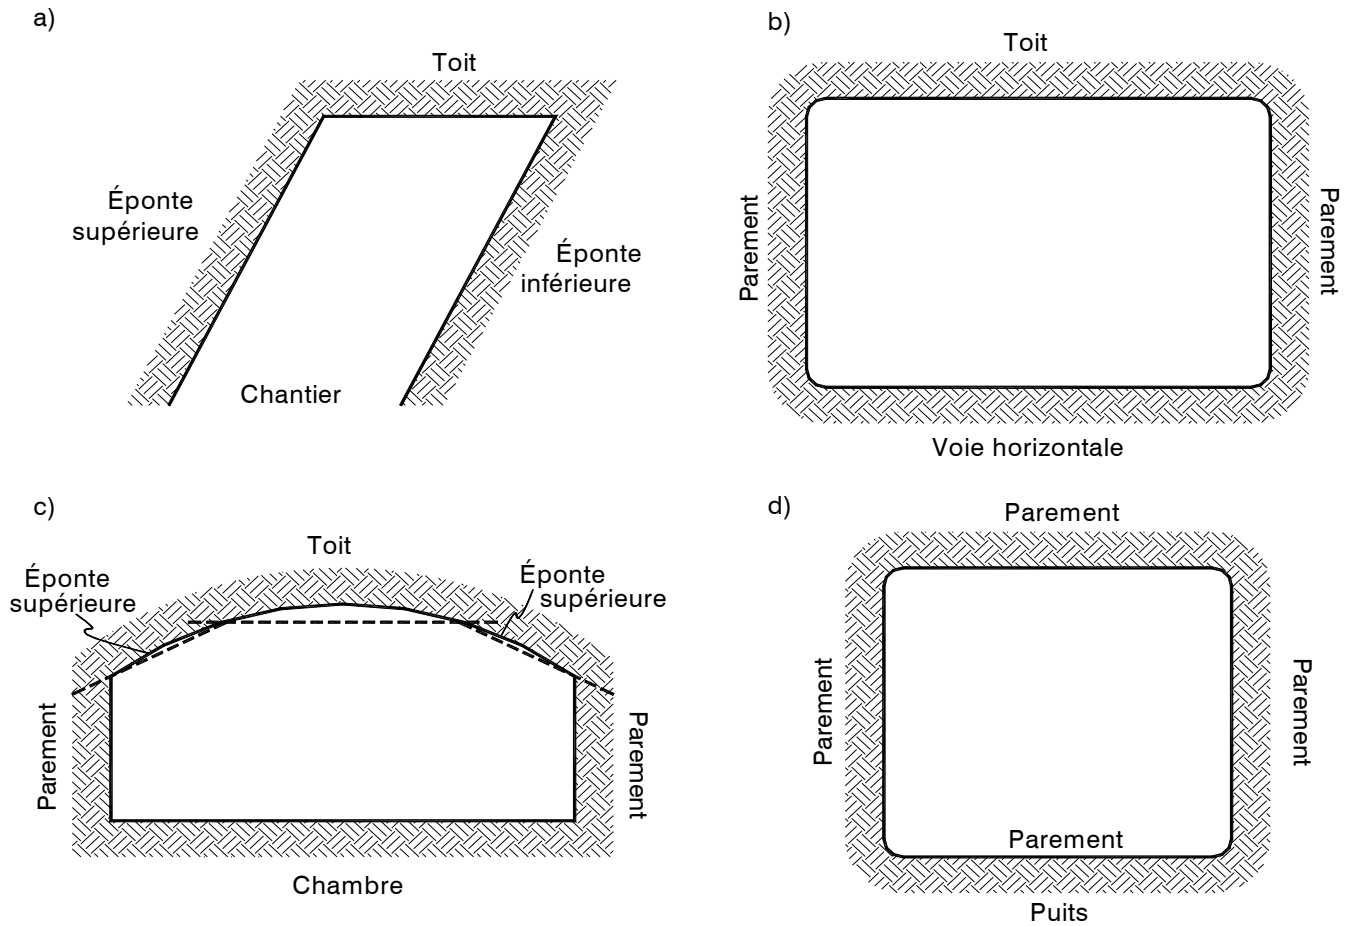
Nomenclature des parois des excavations souterraines. (a): Section verticale d'un chantier de mine. (b): Section verticale d'une voie horizontale ou d'une chambre de petites dimensions. (c): Section verticale d'une chambre de grandes dimensions. (d): Section horizontale d'une voie verticale.
